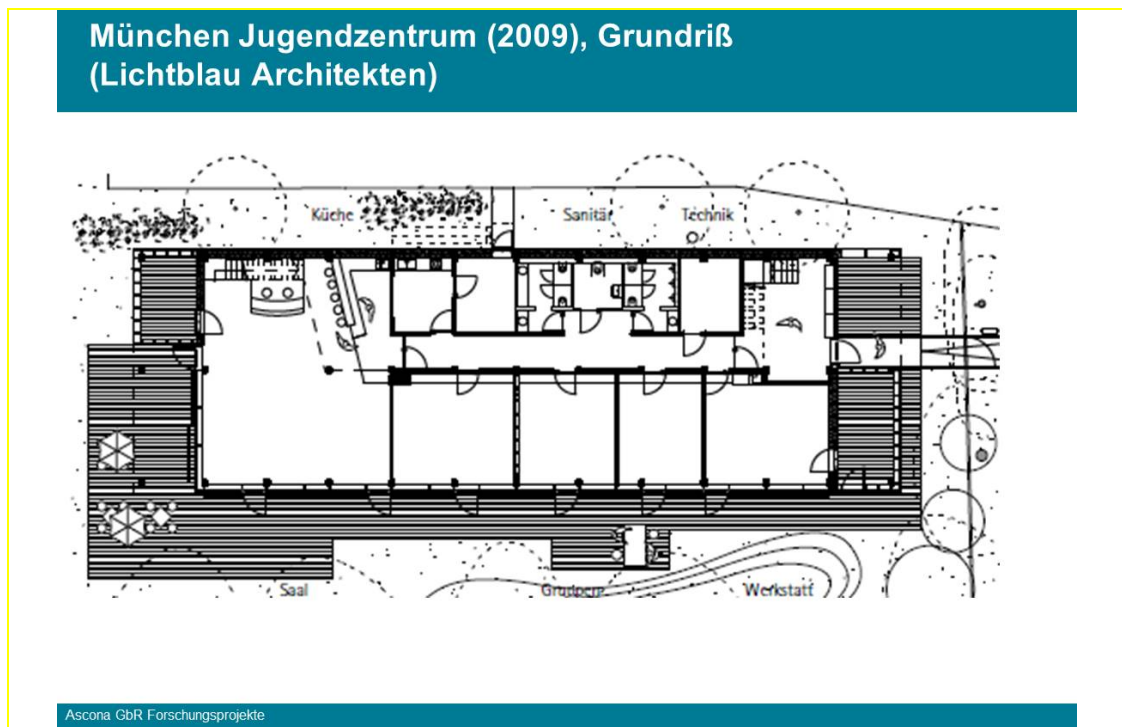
Jugendzentrum München, Grundriss
